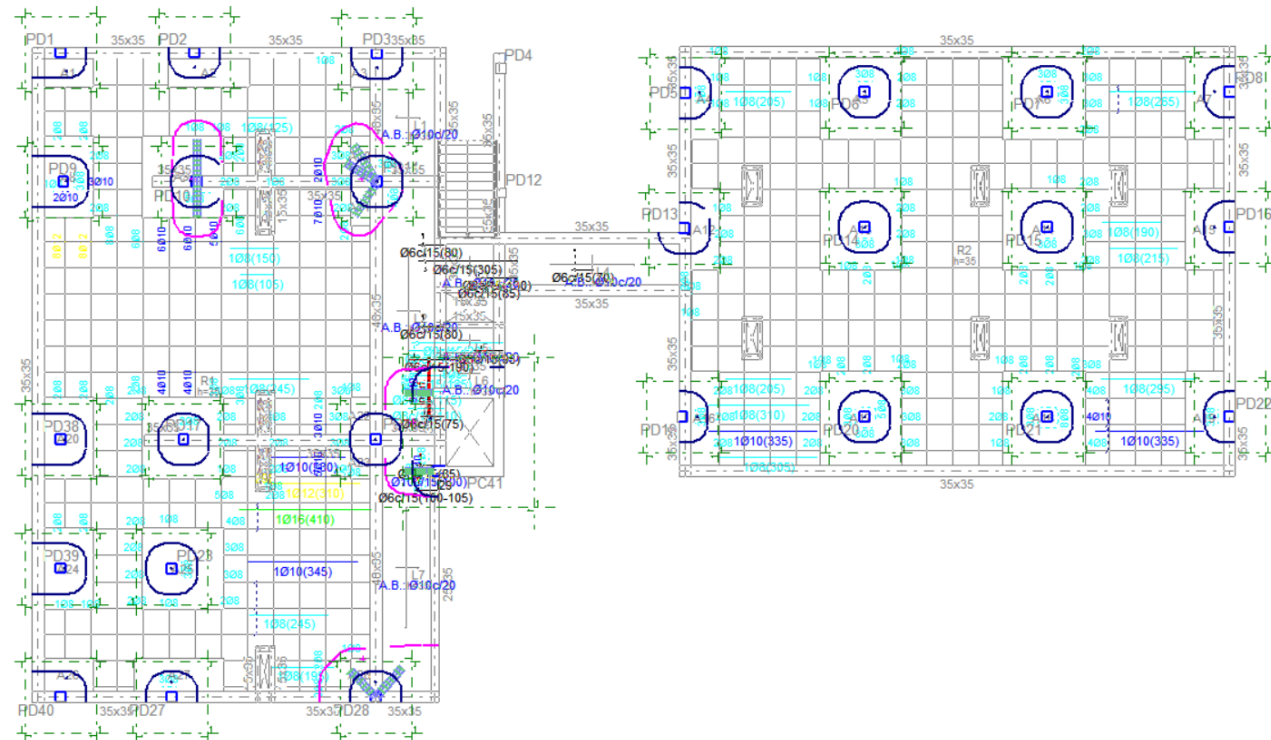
Punzonamiento Planta Cuarta, Módulo D
